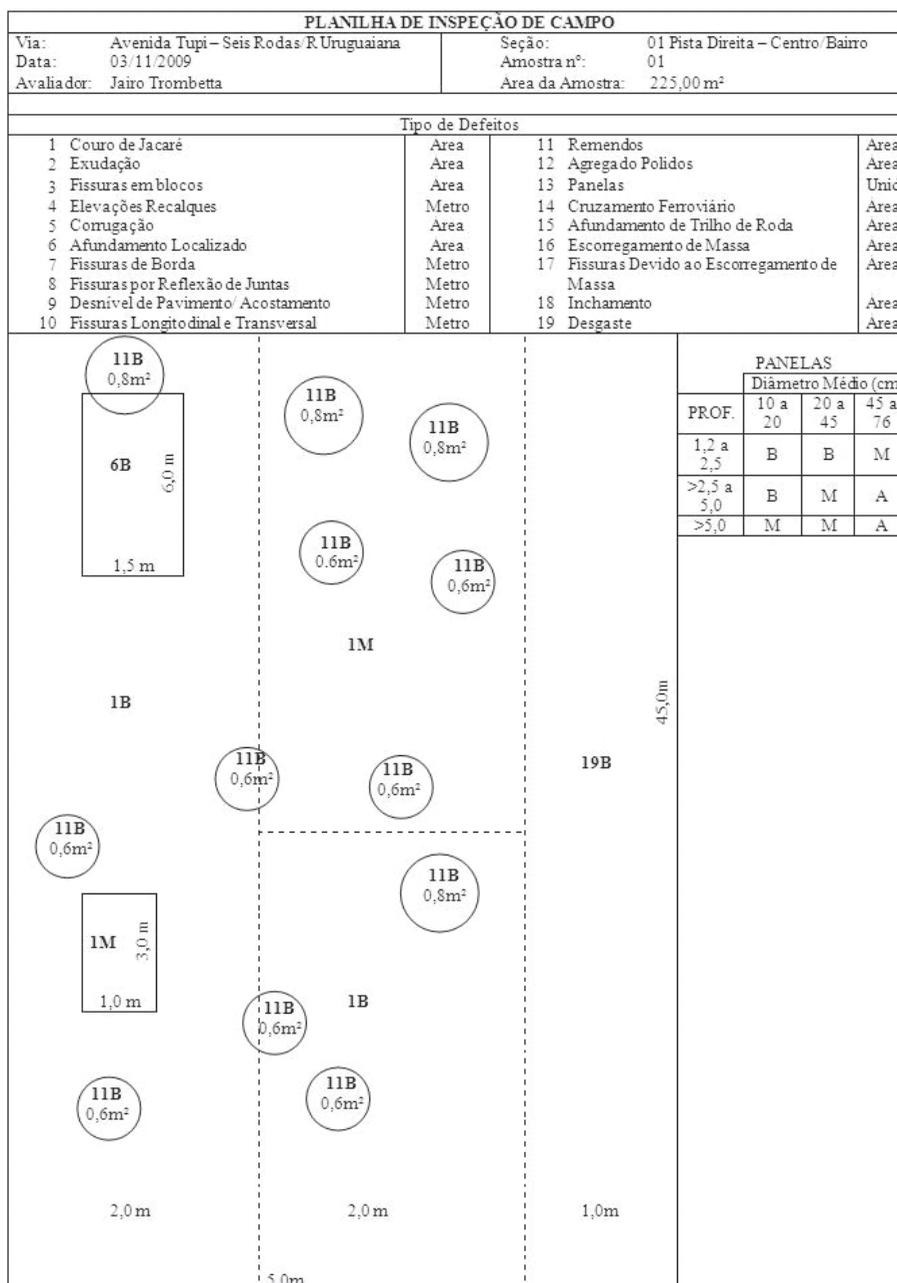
Planilha de levantamento da seção 1, pista direita do Trecho 1
